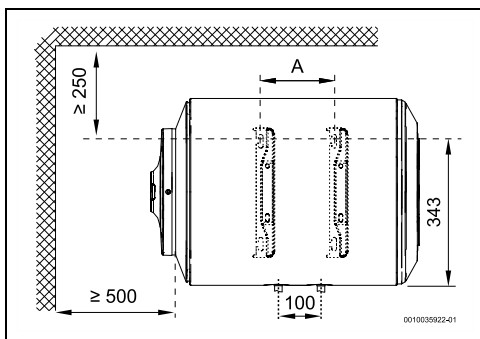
Dimensiuni în mm (montare pe perete, instalare orizontală, TR1000...H)
